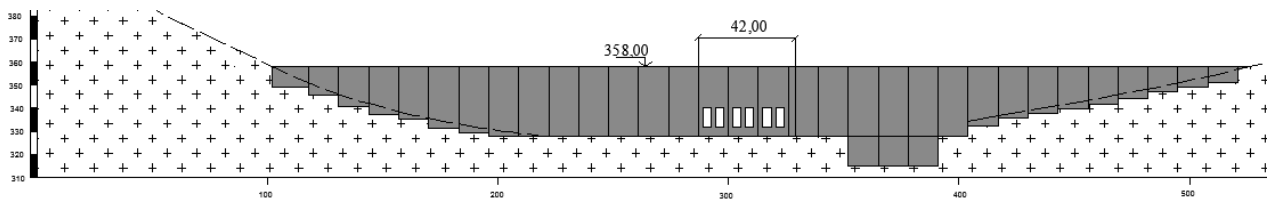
Поперечный разрез плотины на втором этапе строительства
